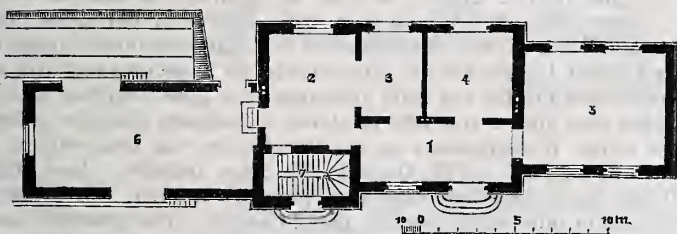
Grundriss vom Erdgeschoss.
